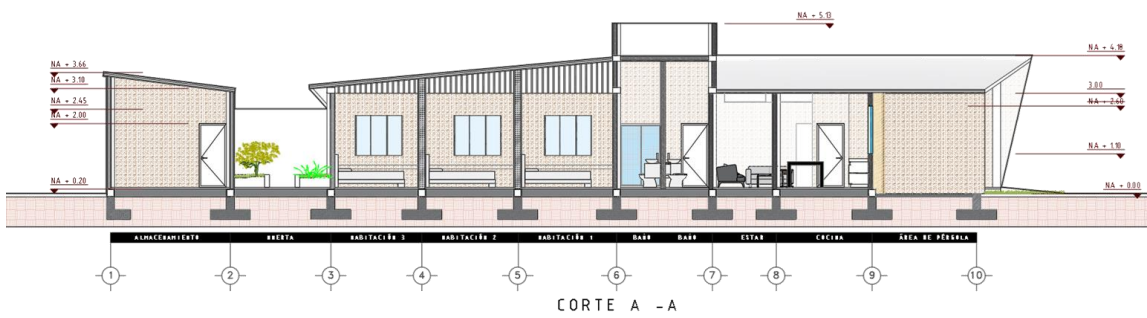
Propuesta arquitectónica. CORTE LONGITUDINAL
